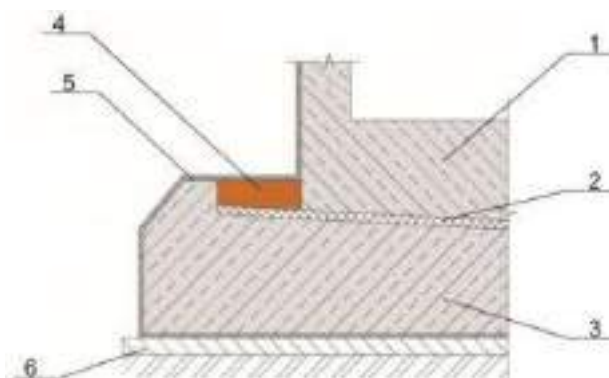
Схема сейсмоизолирующего скользящего пояса: 1) нижняя часть здания в уровне фундамента; 2) фторопластовые пластины; 3) фундамент; 4) демпфер (песок крупный); 5) гидроизоляция; 6) бетонная подготовка.
